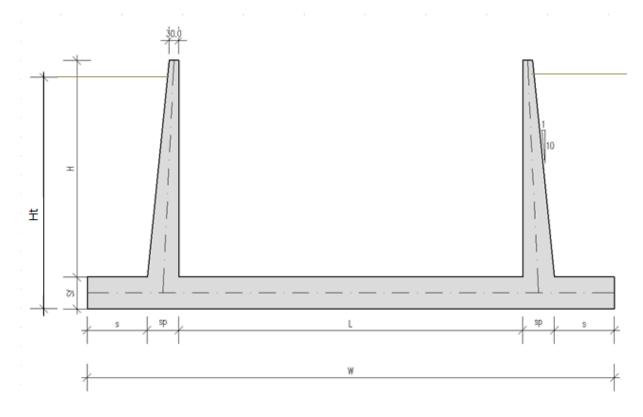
1 - GEOMETRIA DELLA SEZIONE DEL MURO AD U
